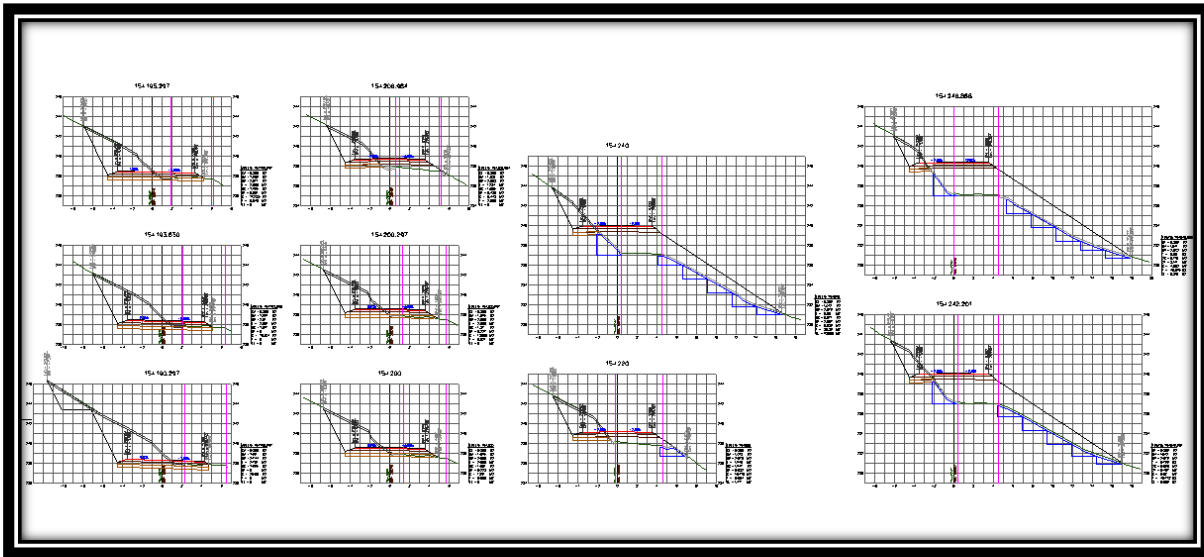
Secciones de construcción del km 15+190.297 al km 15+248.868.
